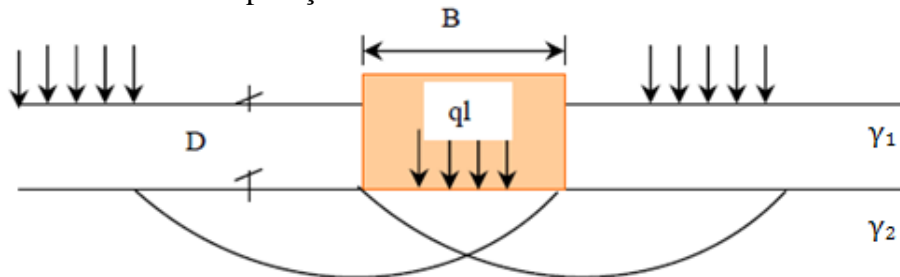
Mécanisme poinçonnement d'une fondation superficielle
